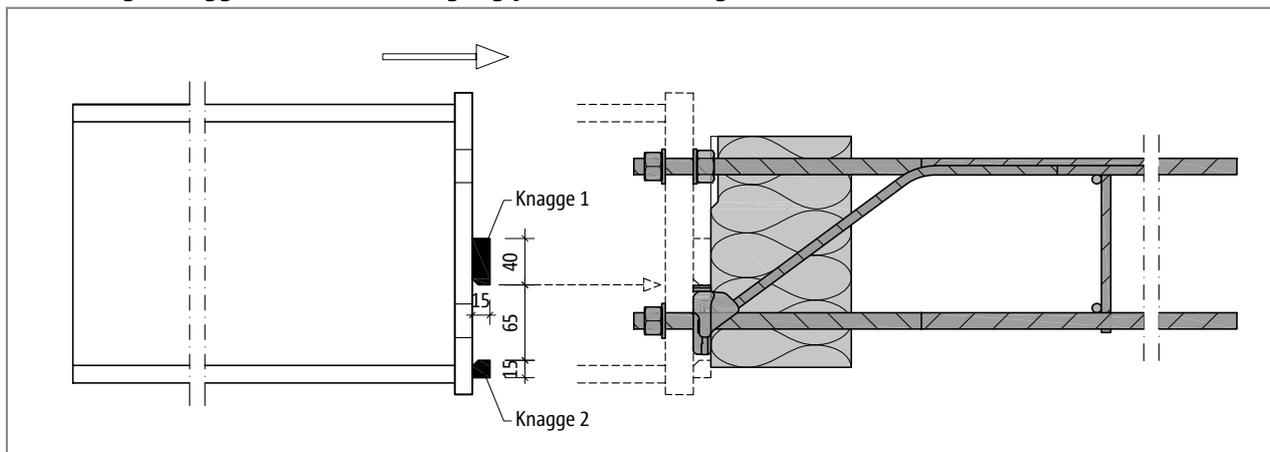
Schöck Isokorb® XT Typ SK: Montage des Stahlträgers
